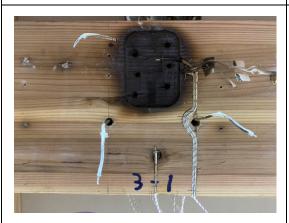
試験体 3-1 耐火構造壁内の梁(スギ集成材)表面
